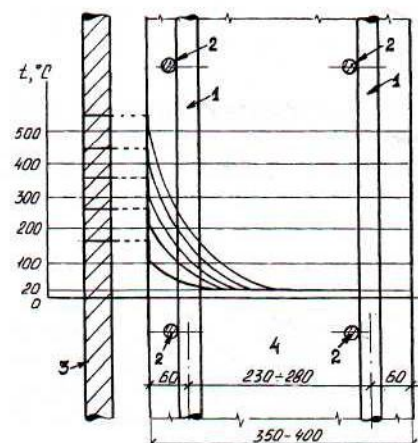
Температуры нагрева железобетонной стенки ствола башни и предварительно напряженных канатов
